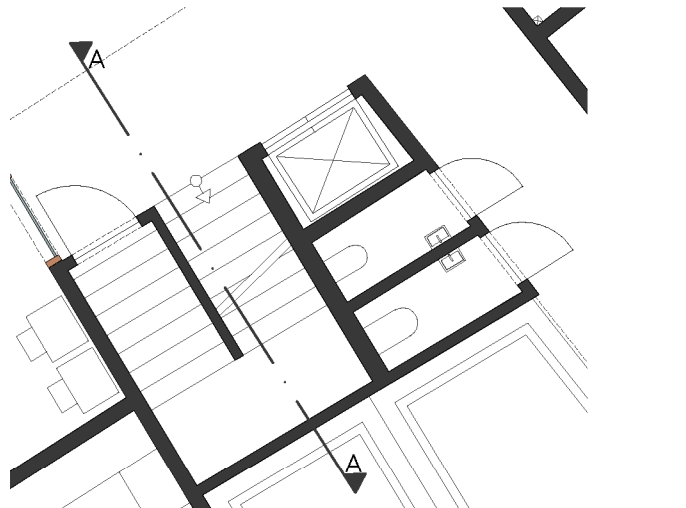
Grundriss Erdgeschoss Erschließungskern 1:100
